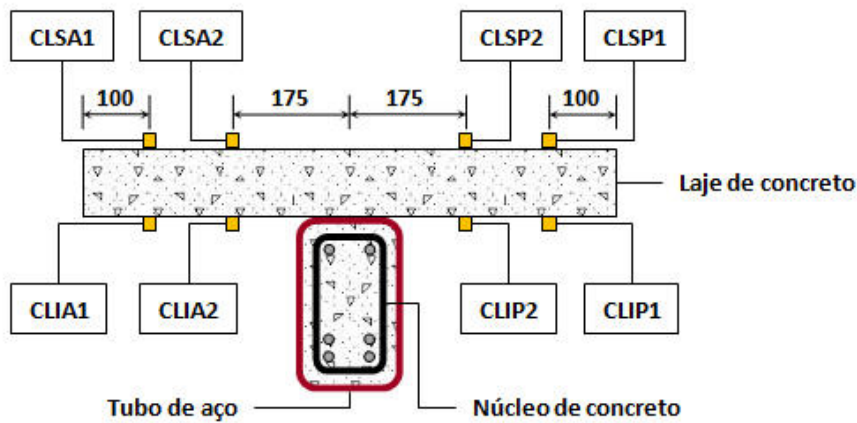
Ensaio de flexão: designação dos extensômetros na laje de concreto
